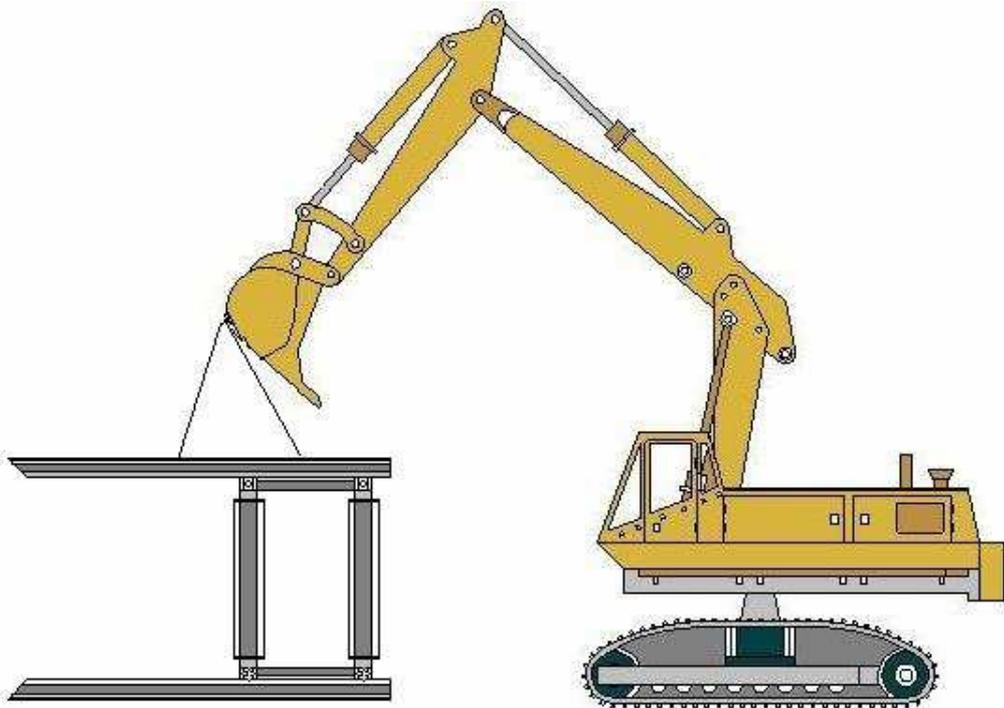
Montaje final del segundo pilar utilizando una excavadora./Elaboración Propia.
